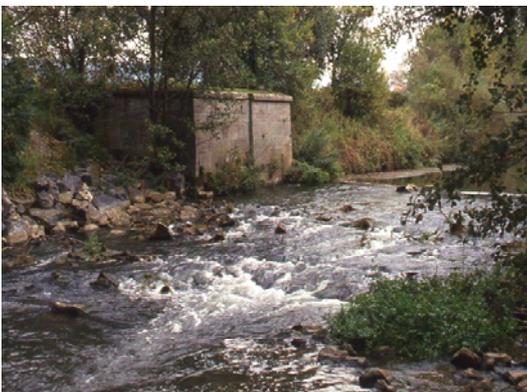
Ehemaliges Wehr bei Obernjesa zu rauer Sohlgleite umgebaut und durchgängig
